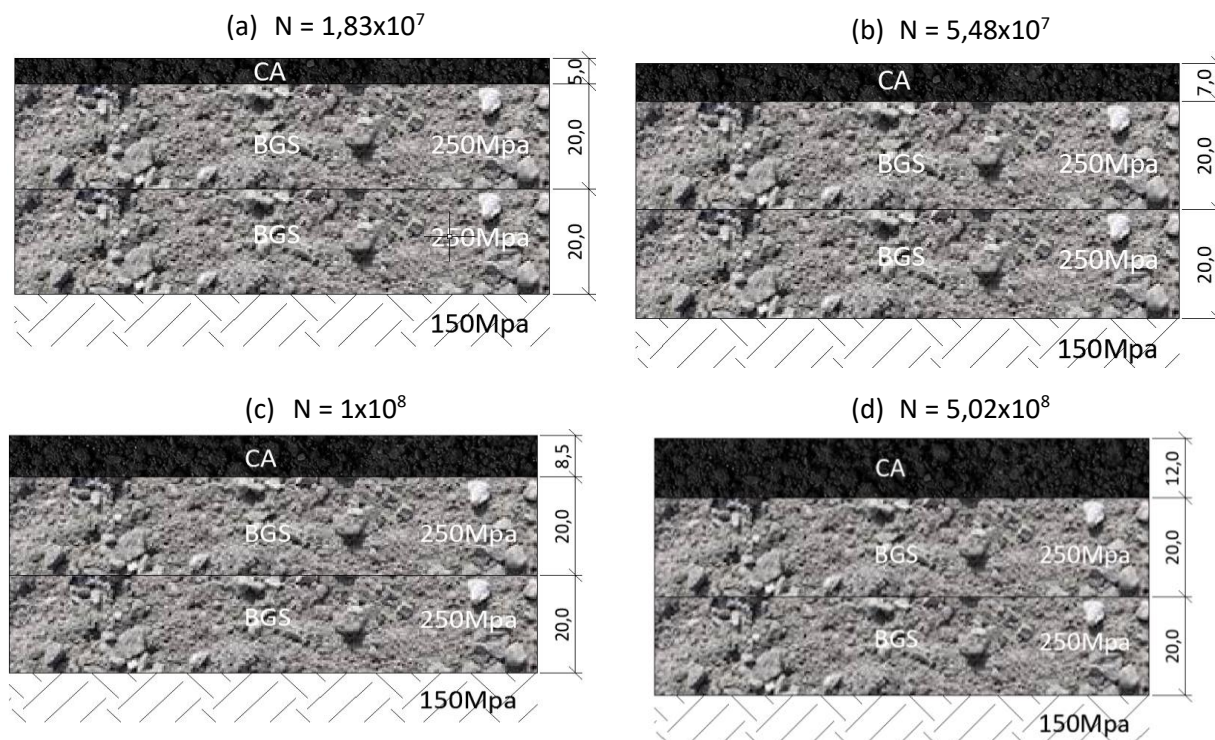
Seções transversais das estruturas em concreto asfáltico modificado por polímero
